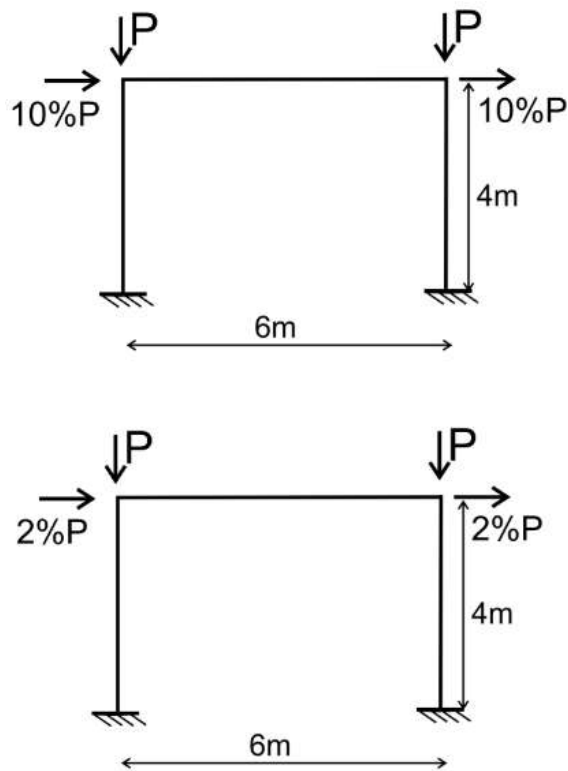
Carregamento aplicado nos pórticos em estudo
